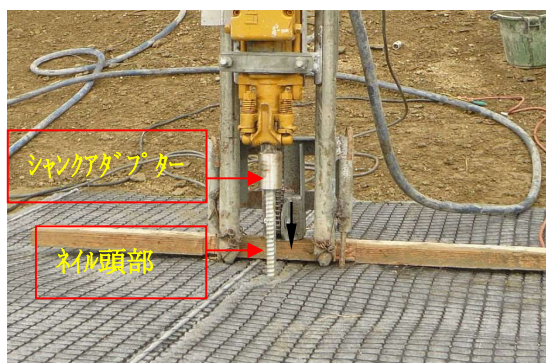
ウインチ使用 人力移動での鉄筋打込み作業状況
